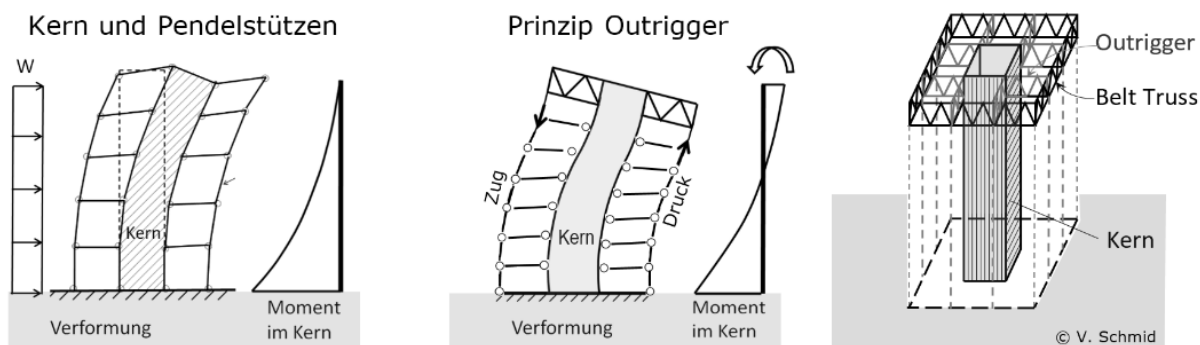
Aussteifung mit Kern (links); Kern und Outrigger (mitte); Outrigger und Belt Truss (rechts)
